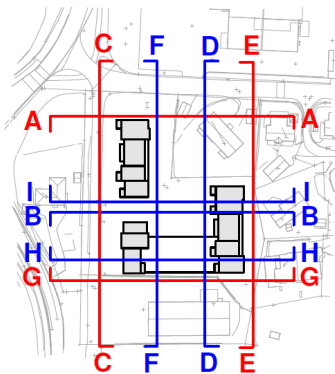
Utsnitt fra illustrasjonsplan – forenklet fremstilling
